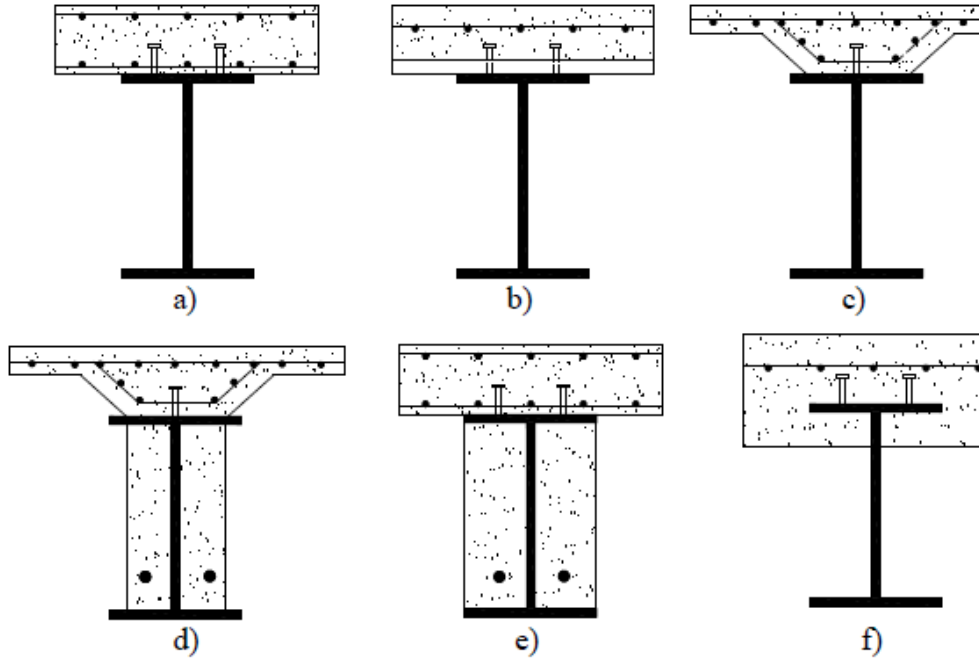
Kompozit kirişlerde kullanılan çelik enkesitler (Arda ve Yardımcı, 2000; Damar, 2006)
